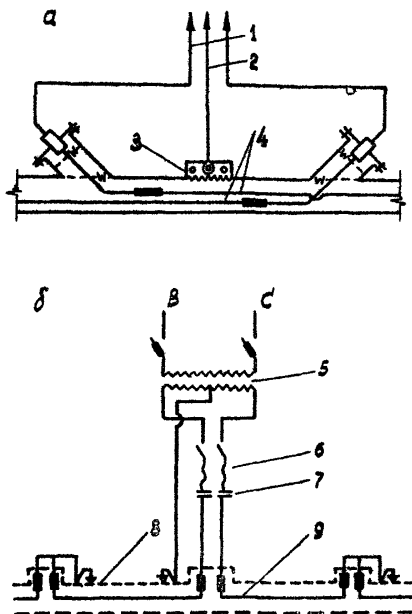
Схема прокладки греющего кабеля внутри трубопровода:
